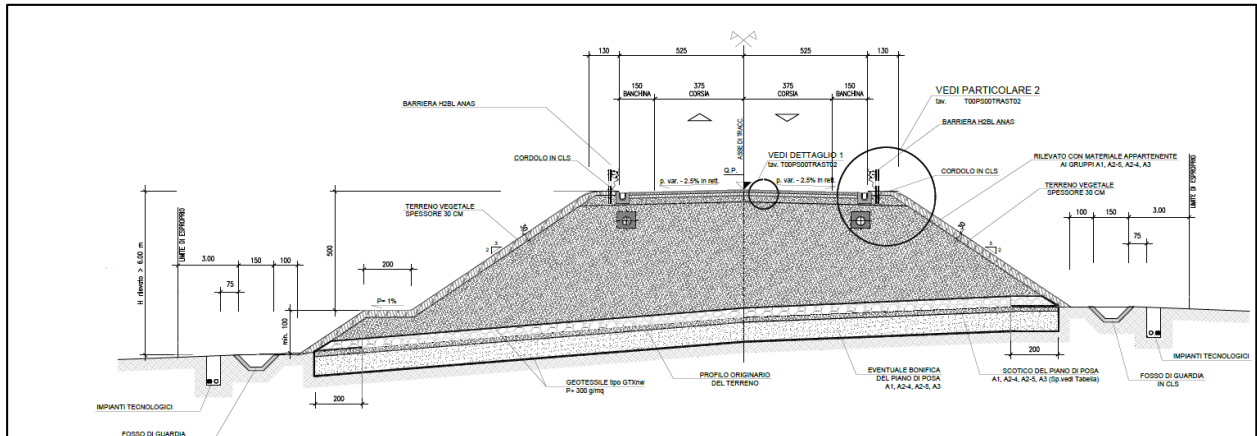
Sezione tipo C1 in rilevato con H>5 e H<6
